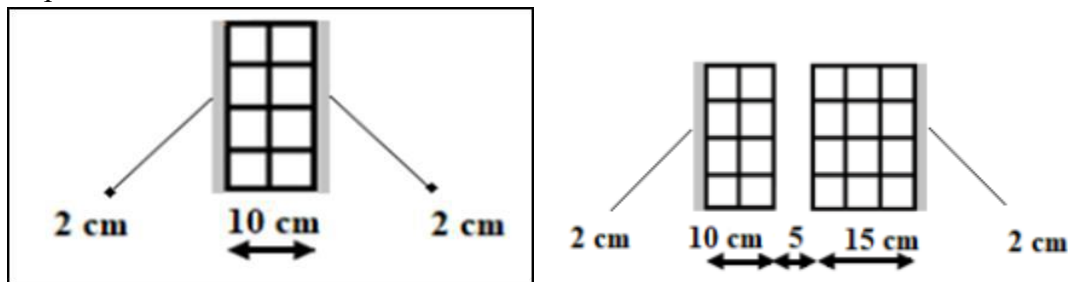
Coupe transversale d'un mur intérieur et extérieur.
